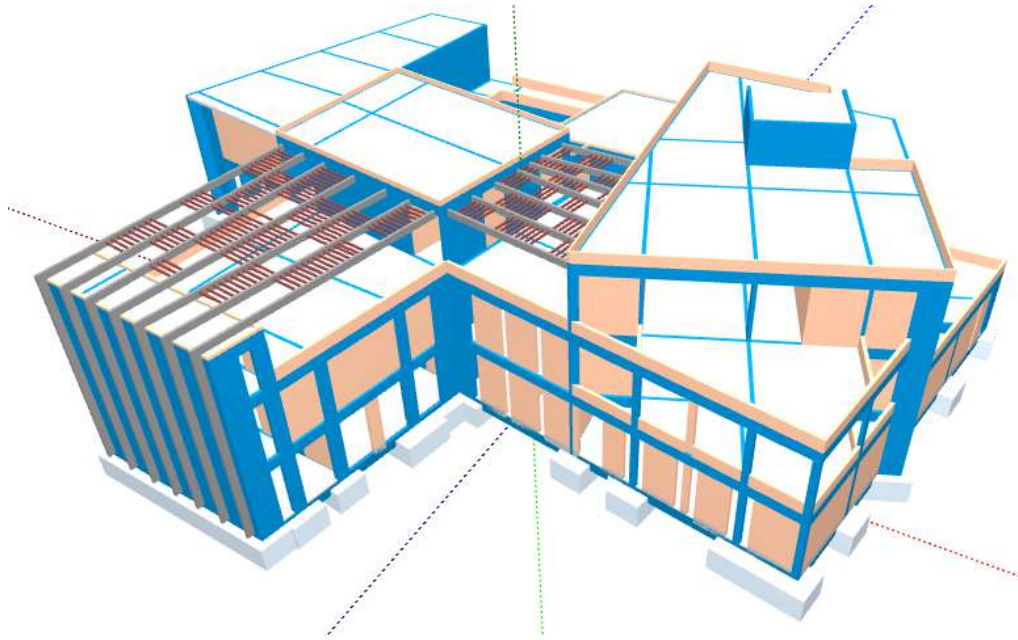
Levantamiento en BIM - Vista general de estructuras.
